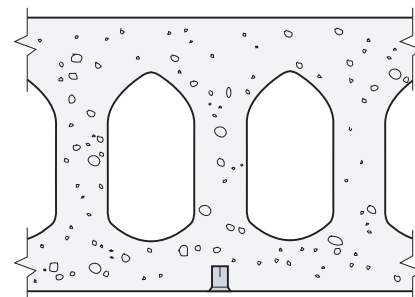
Panel de concreto con núcleo hueco (el anclaje puede instalarse debajo del refuerzo o del núcleo hueco)
